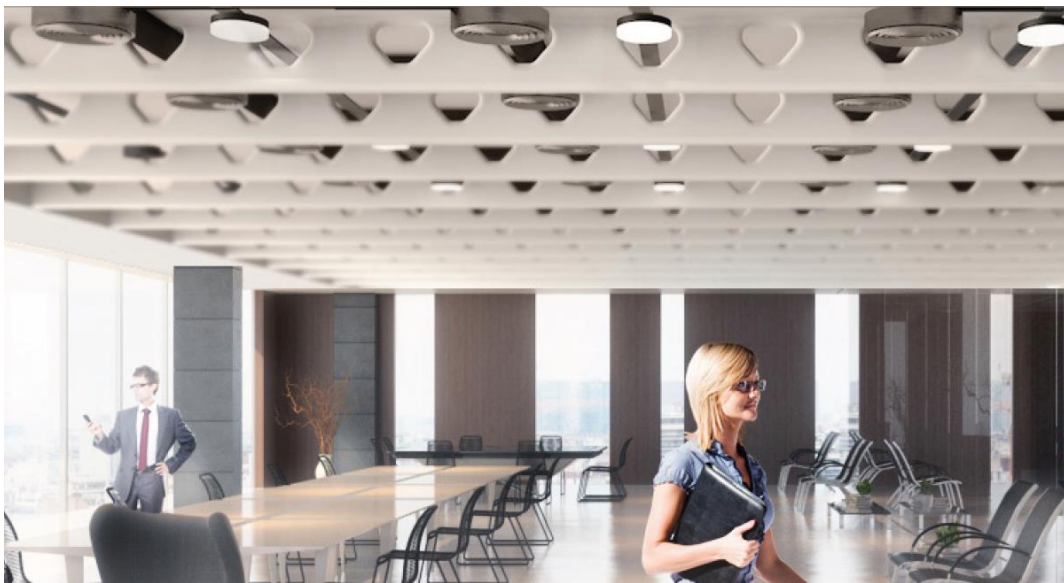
Fotomontaje forjado HOLEDECK Ho-One (HOLEDECK, 2018)
